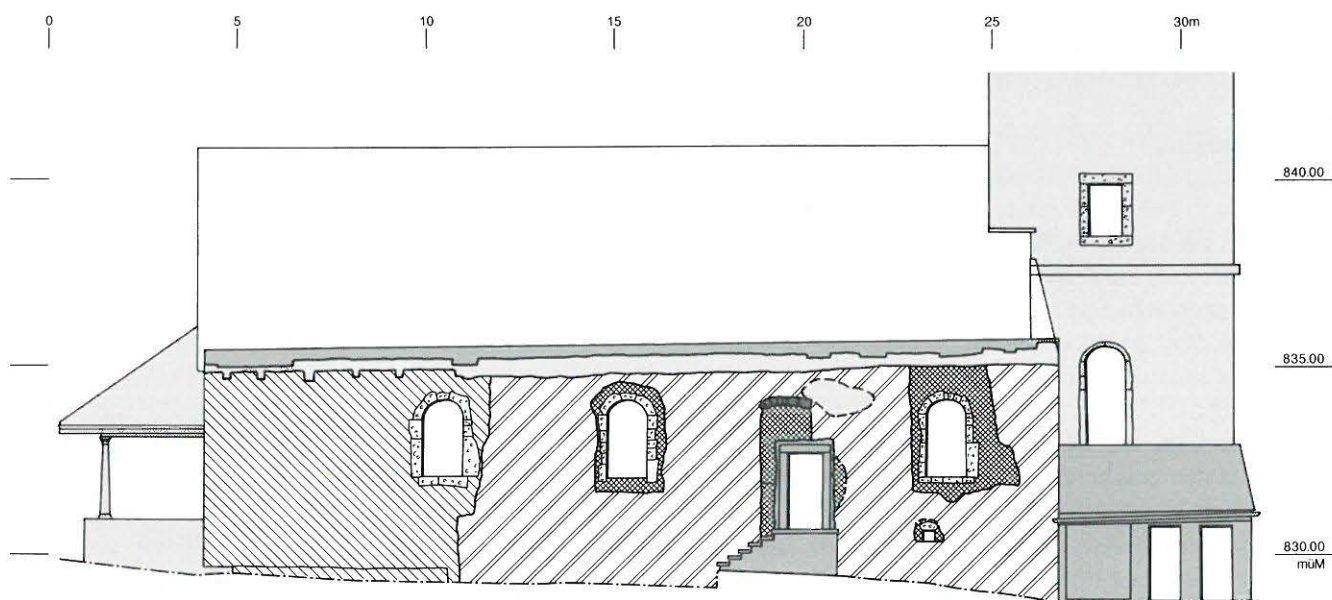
Boltigen, Kirche. Südfassade mit Turm und Bauphasen. M. 1:200. Legende s. Abb. 177.
